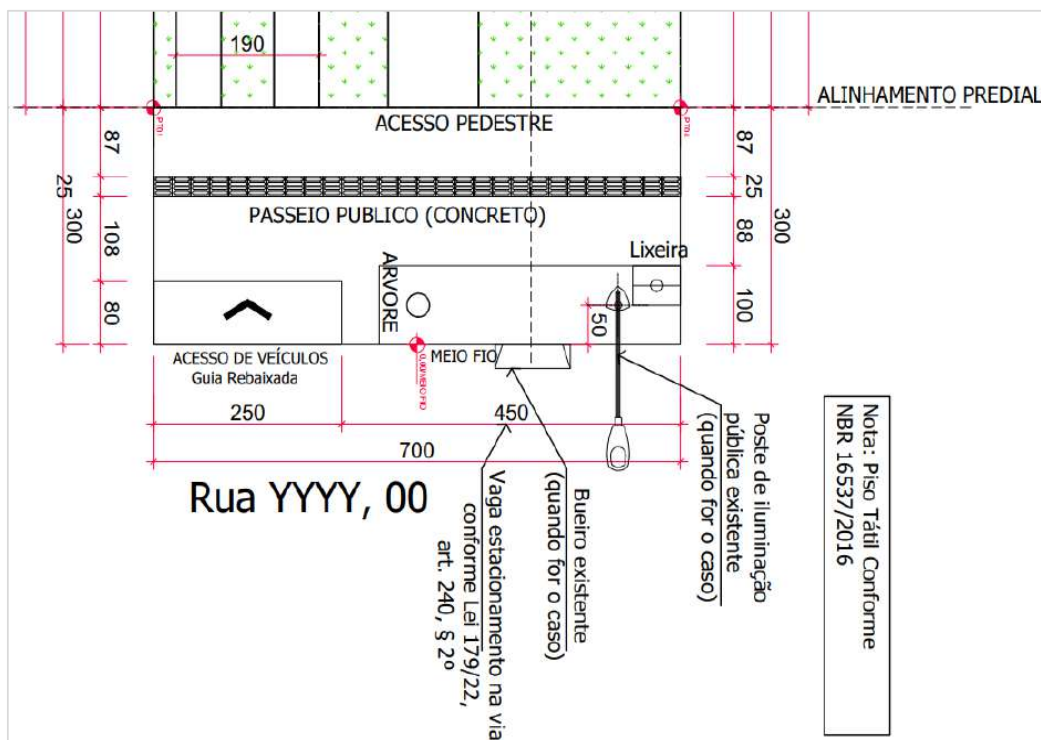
Detalhamento da calçada de um lote típico. Fonte: Projeto Arquitetônico.
